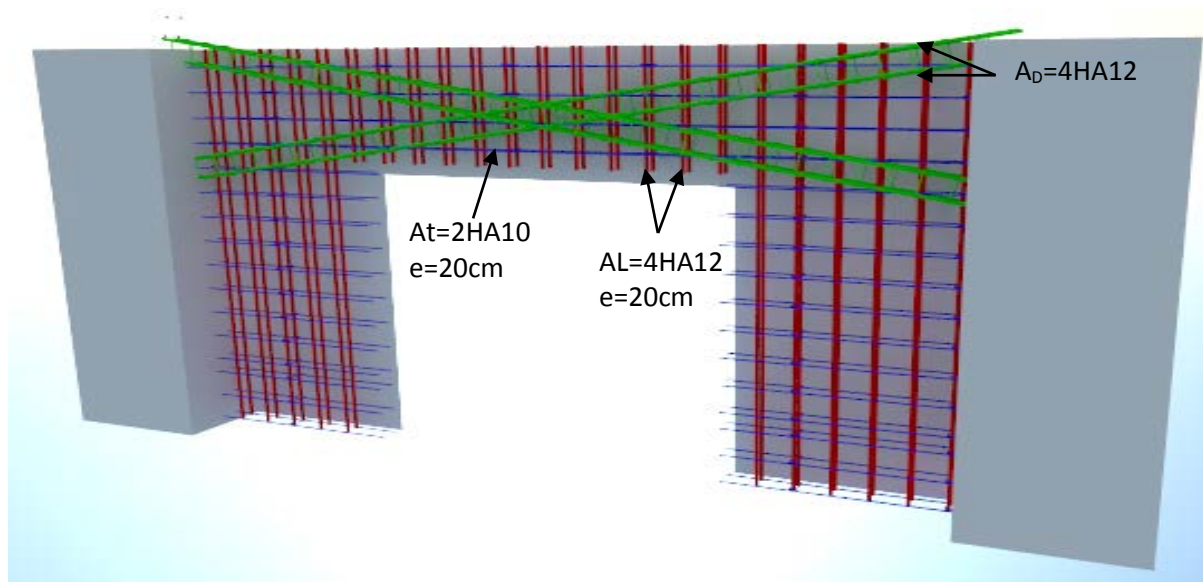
Exemple de Ferraillage du linteau en 3D.
